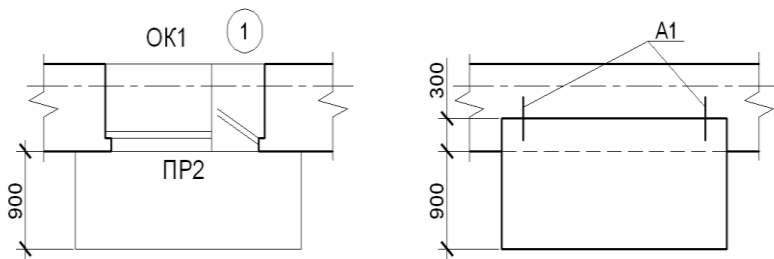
Изображение балкона на плане этажа и плане перекрытия
